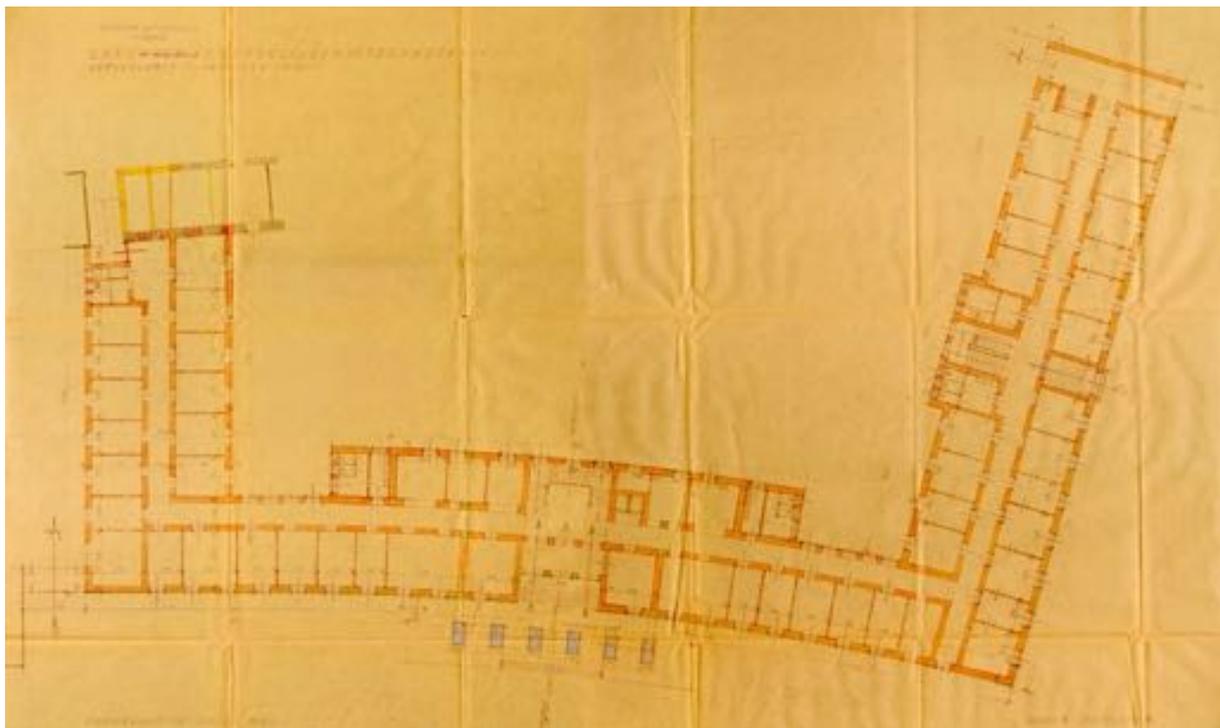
, Walter und Ewald Guth, Landhaus-Erweiterungsbau, Wettbewerbseinreichung, Grundriss des Erdgeschosses. Die Brüder Guth gehen von 6 Pfeilern der vorgesetzten Eingangshalle aus und planen ein zentrales Treppenhaus. Die Südflügel werden zum Teil von Räumen zu beiden Seiten gesäumt. Der rückwärtige Wirtschaftstrakt fehlt (TLA, Plansammlung, Landesbaudirektionspläne, Innsbruck, Landhaus T.39-17).
